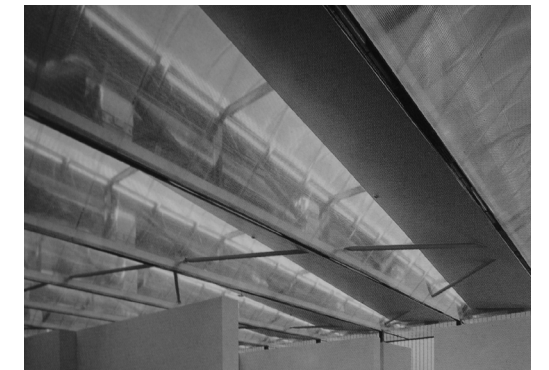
| Detalle de la unión del cielorraso con los arriostramientos de la cubierta del edificio. Kunsthall, Rotterdam.
